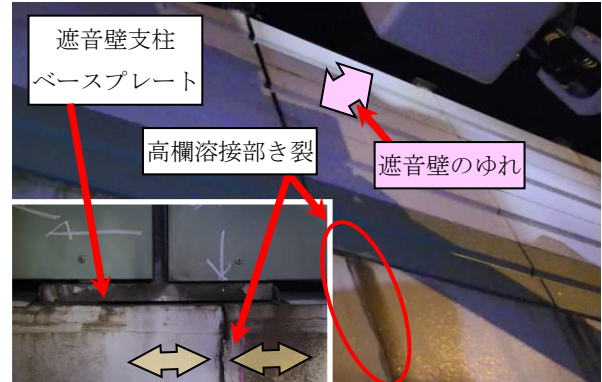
高欄溶接部き裂による遮音壁のゆれ
